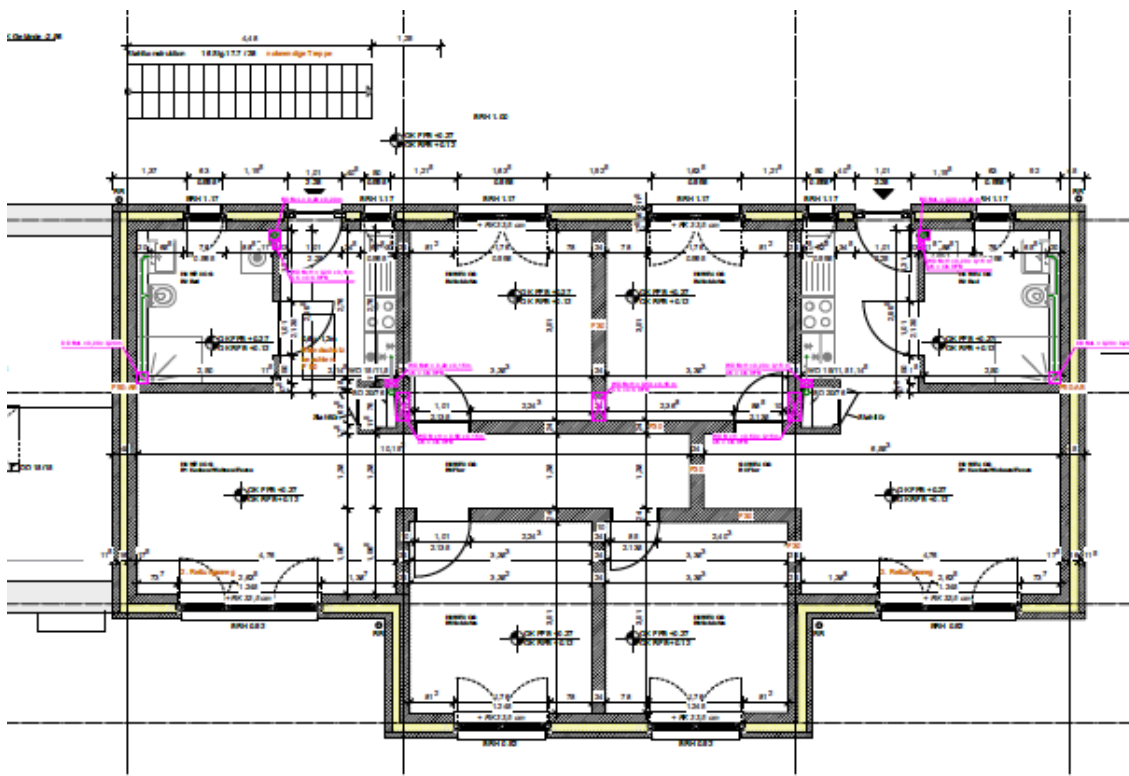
Plan-Ansicht Haus 6 Neubau Hüttenstraße - Grundriss Obergeschoss
